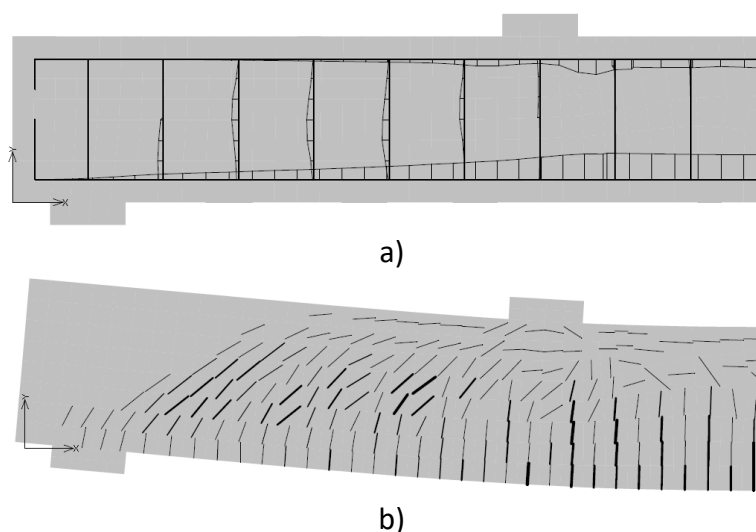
Deformações da armadura e padrão fissuratório.
